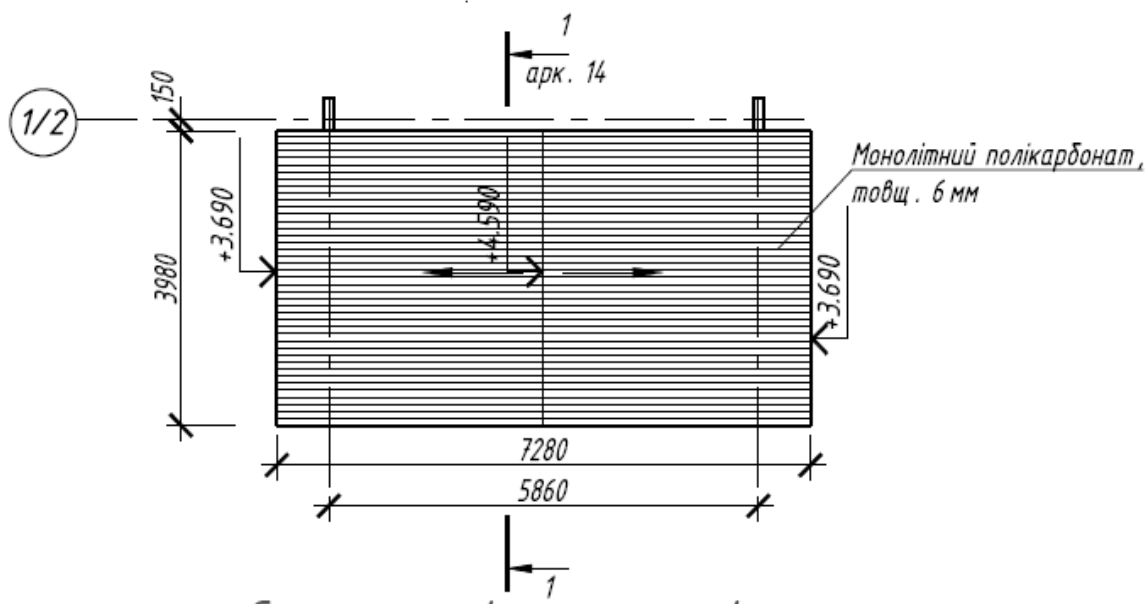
План покрівлі навісу над вхідної групою №1.
